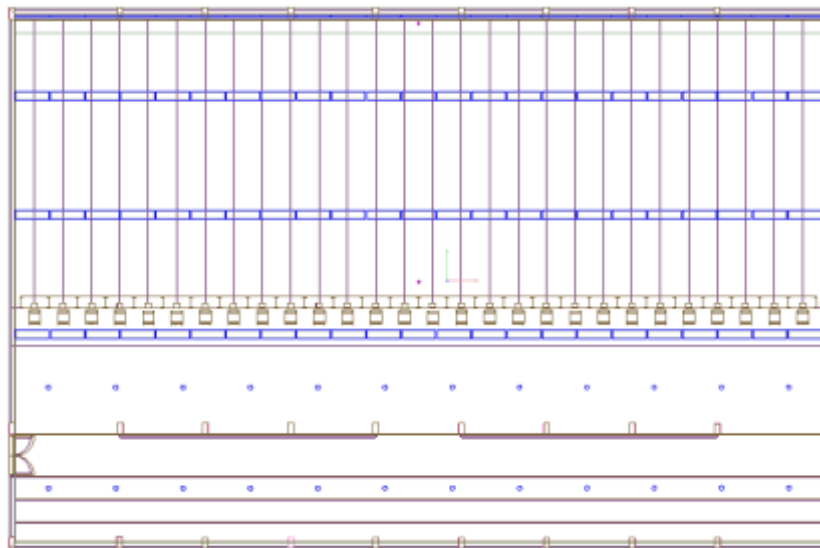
Potongan B-B' Lapangan Tembak Indoor
